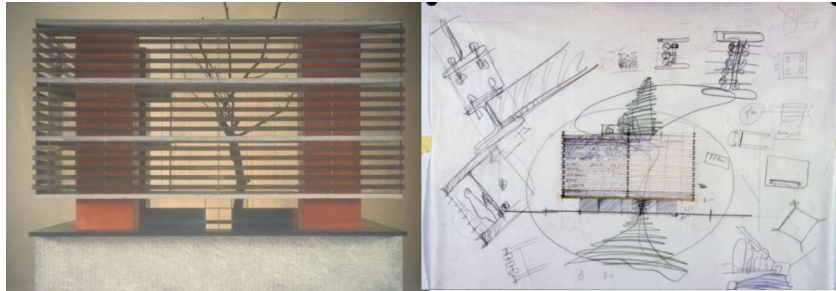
Maquete e esboços da pormenorização da fachada do Banco Ideal da Olivetti do projecto de Souto de Moura
